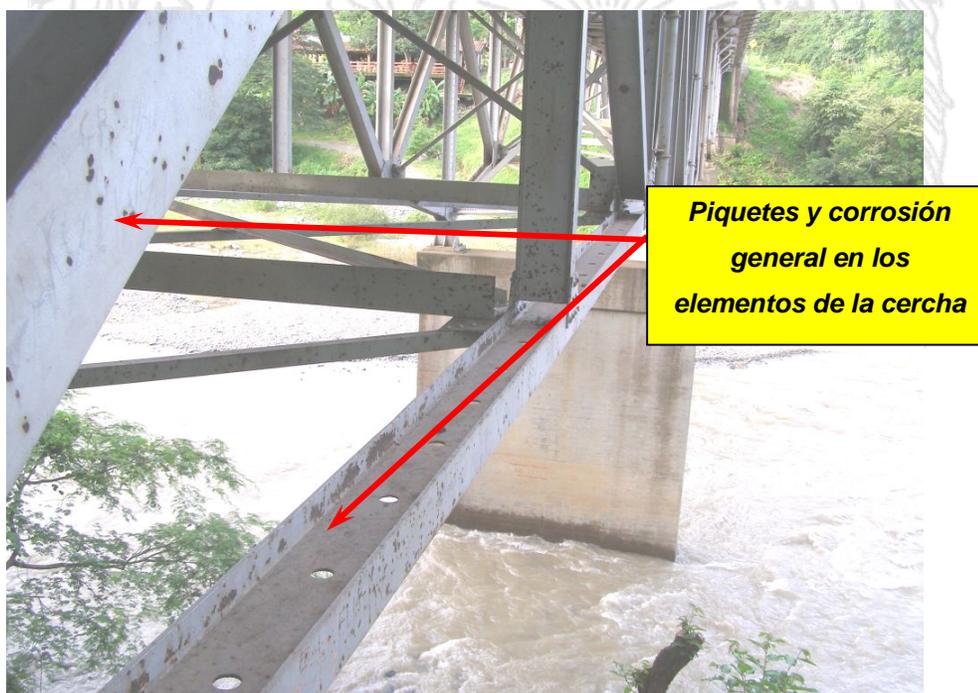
Las cerchas, vigas principales y elementos de arriostamiento exhiben piquetes de corrosión y oxidación leve.
